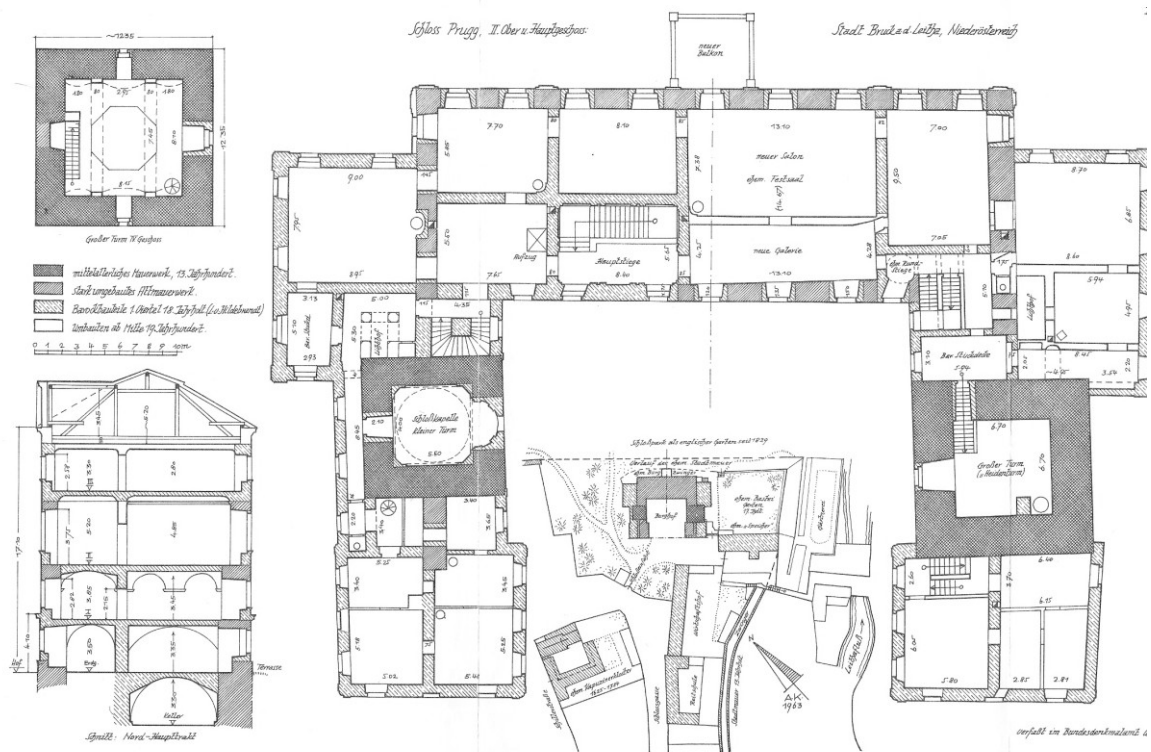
Baulterplan Schloss Prugg, Plan1, Blatt 3/II. Obergeschoss, A. Kloor, Bundesdenkmalamt Wien, 1973 (Quelle: KLAAR 1973)
